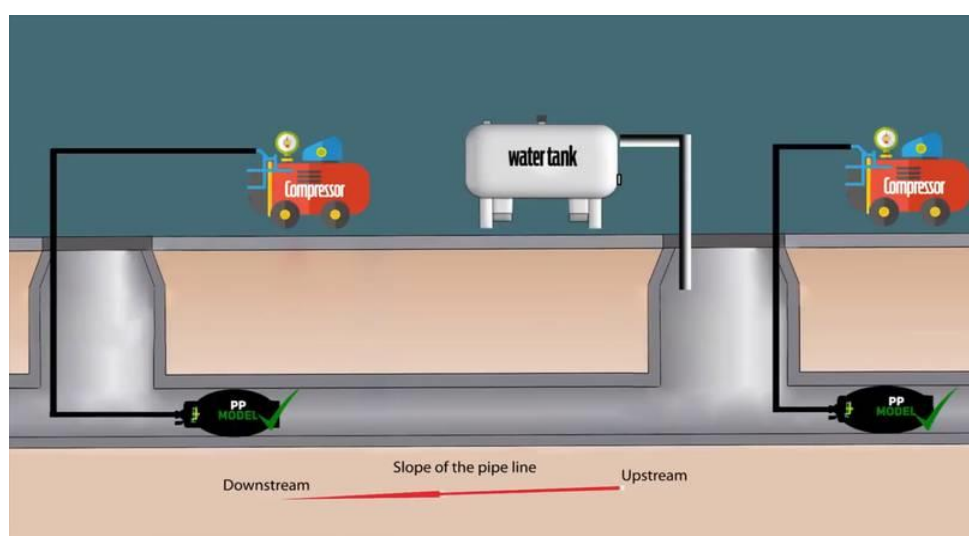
L'essai d'étanchéité à l'air sous pression
